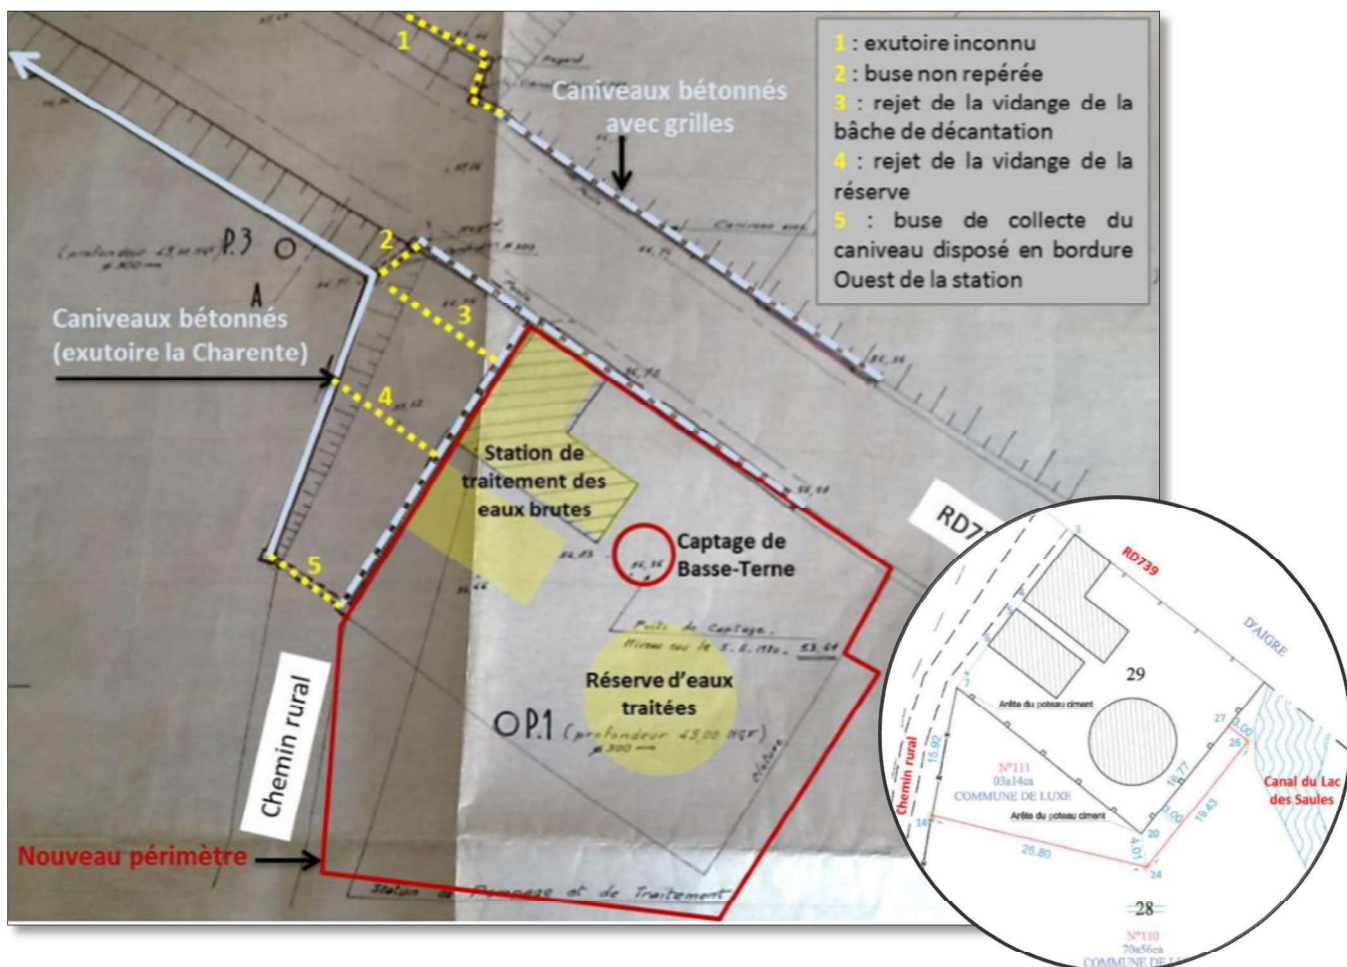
Plan du site avec les différents rejets, en bas à droite : plan d'arpentage de division de la parcelle ZL28.
